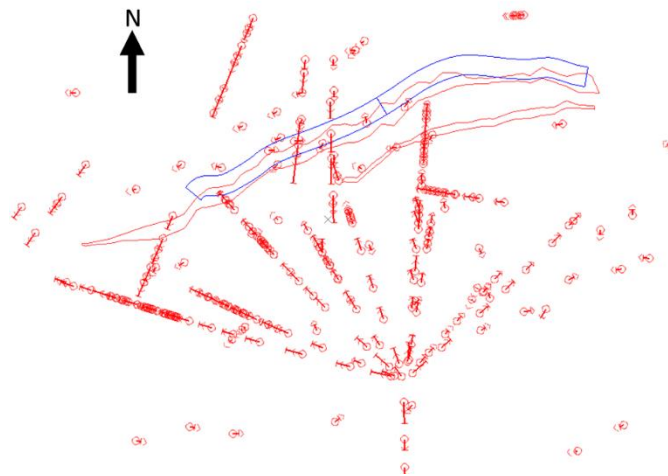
Vista en planta de la propuesta del rebaje 590W (azul) con la traza del mineral (rojo) y se ubican las caracterizaciones realizadas en barrenos y en obra.
